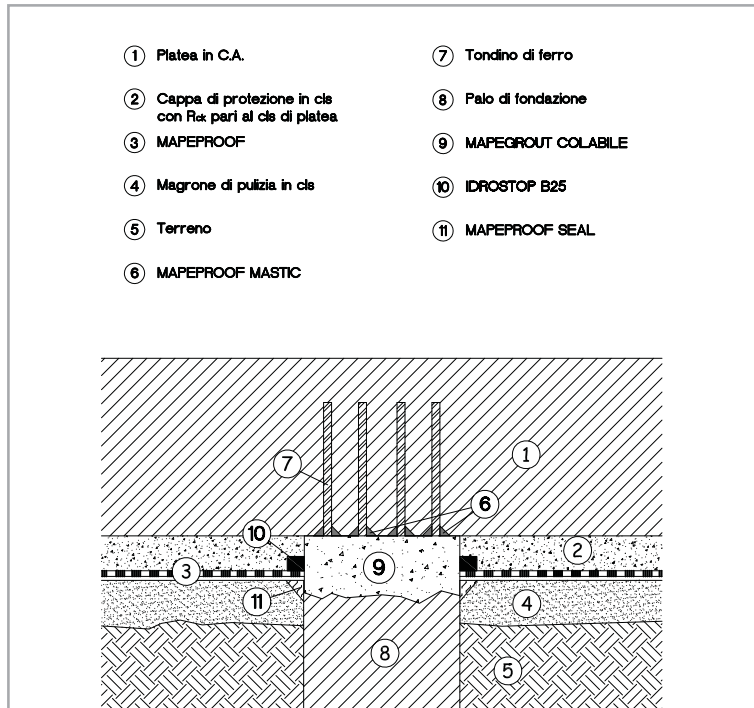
Particolare tecnico dell'impermeabilizzazione della testa del palo collaborante con la platea e passante il telo bentonitico
